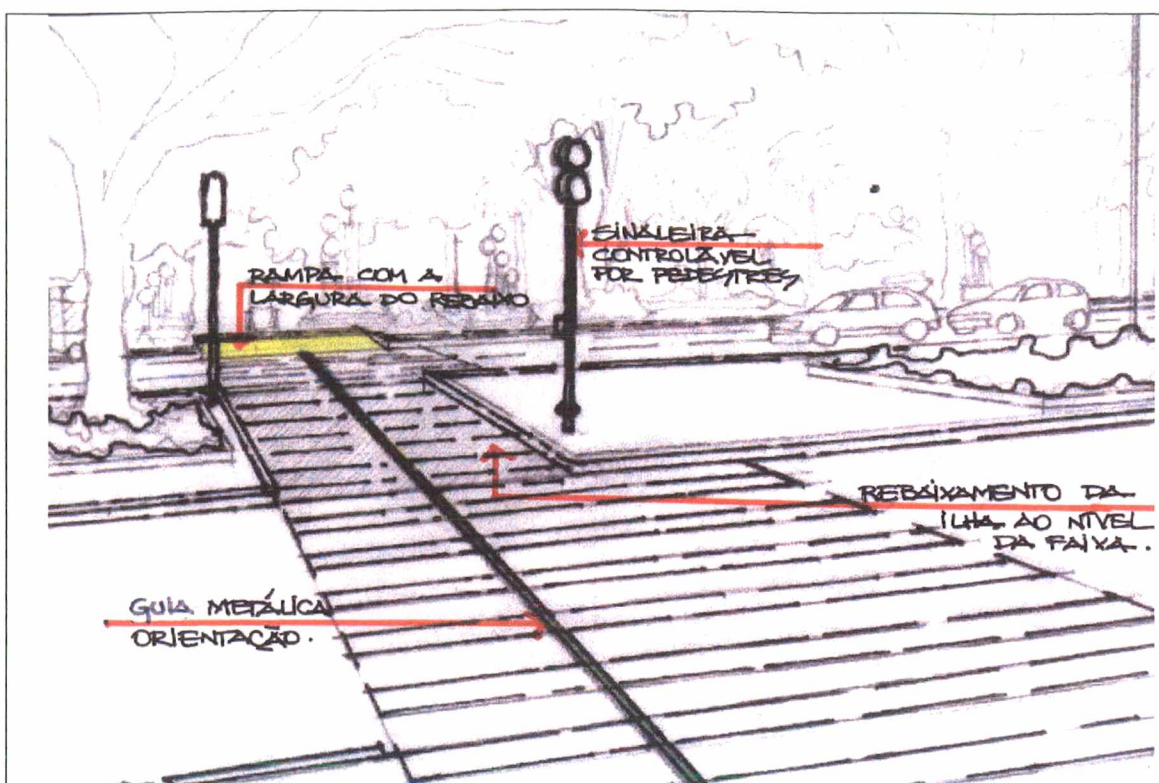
Vista da Travessia da Avenida Tiradentes, com rebaixamento de guias, rebaixamento da ilha e guia metálica na faixa de travessia contínua.
